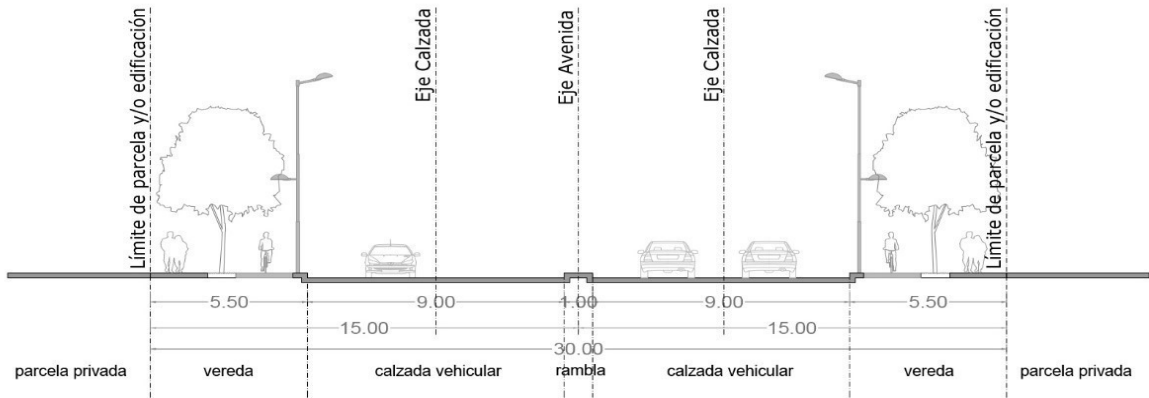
Sección transversal de Vías Avenidas Tipo 1.
